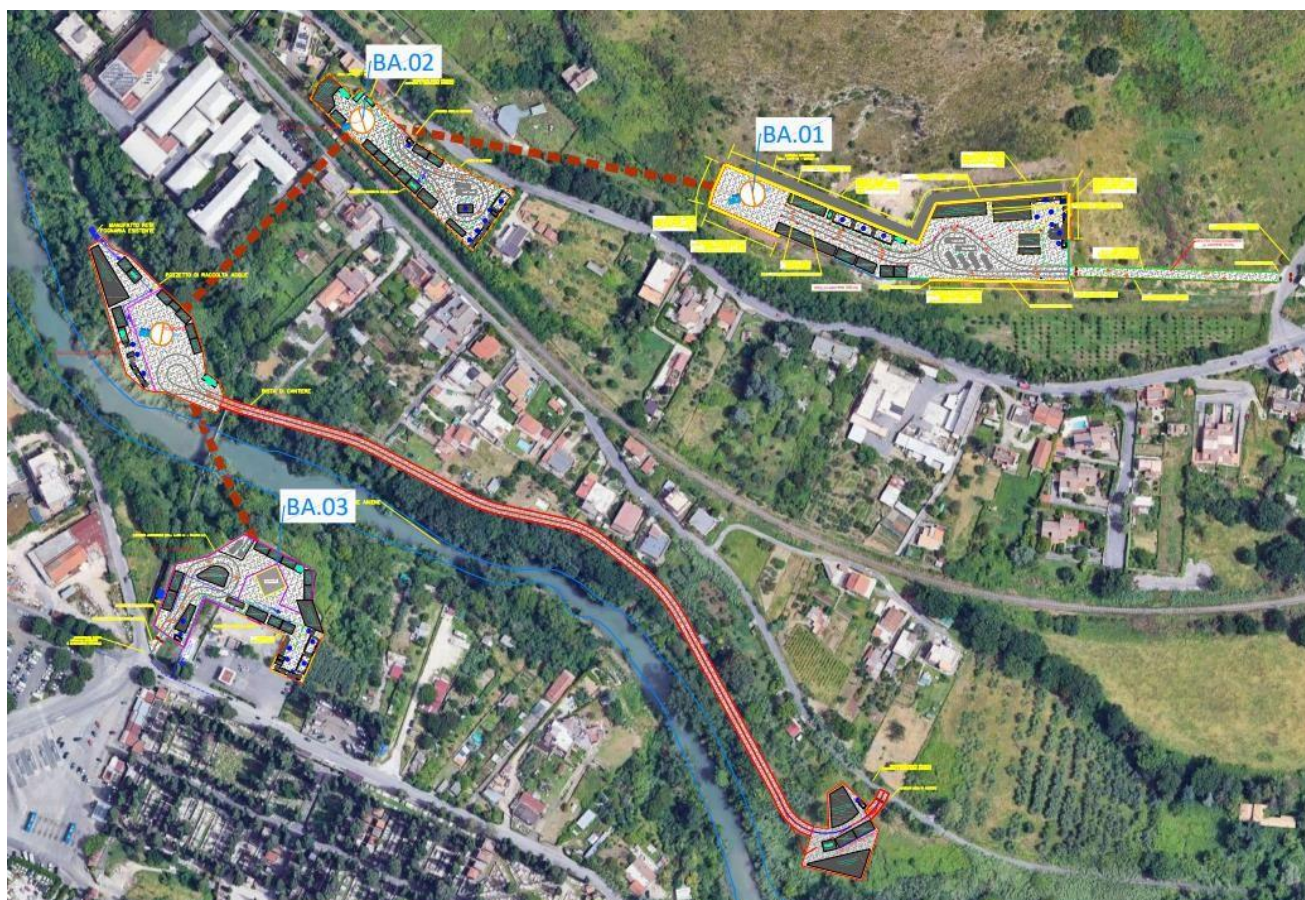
Stralcio planimetrico delle aree di cantiere e relativo posizionamento delle barriere antirumore
